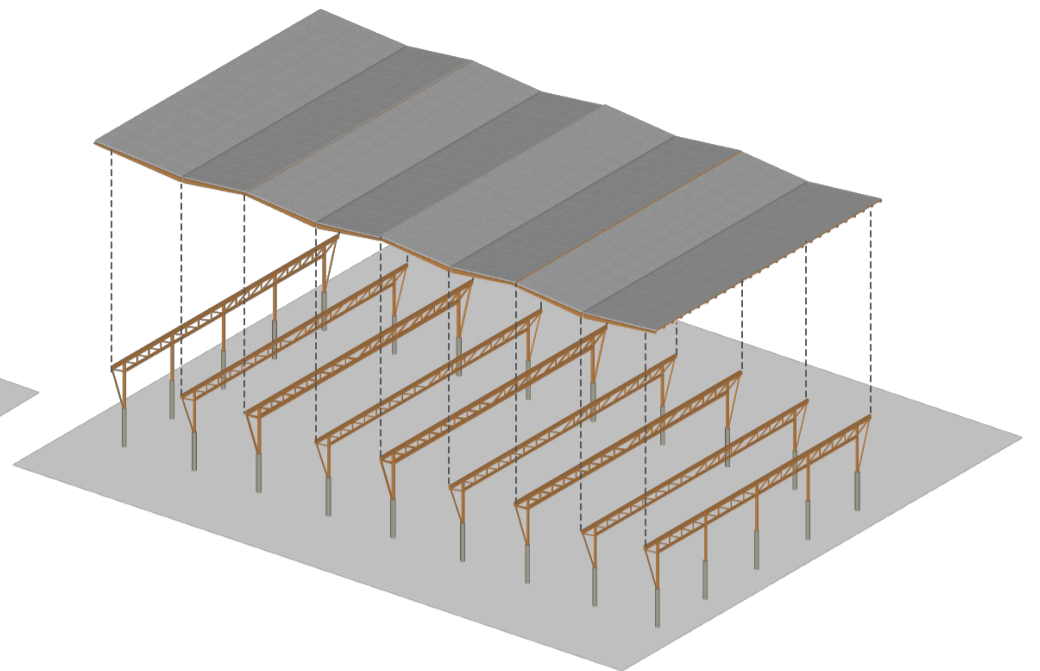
Diagrama estrutural quadra. Fonte: Autora.
